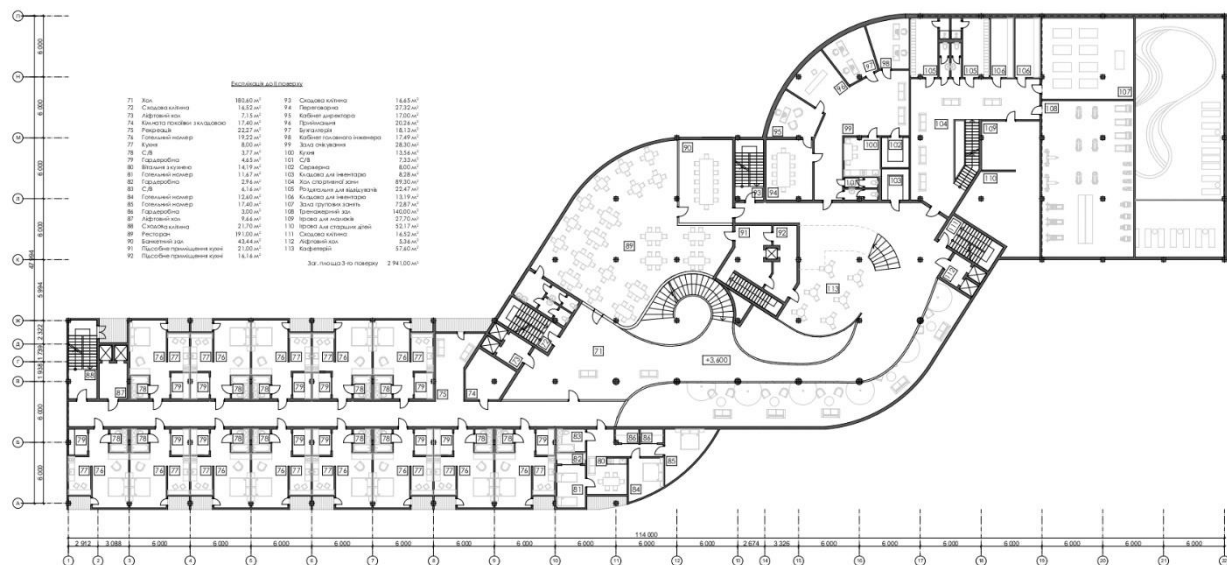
Планування 2-го поверху на відмітці +3.600
